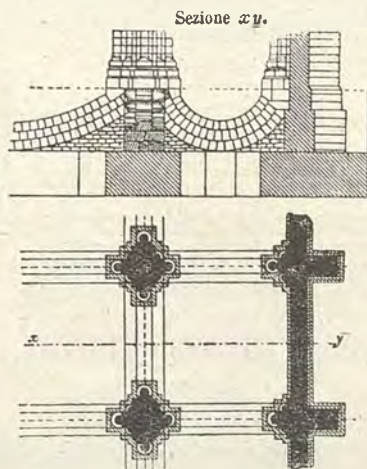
Fondazione a pilastri ed archi rovesci.
